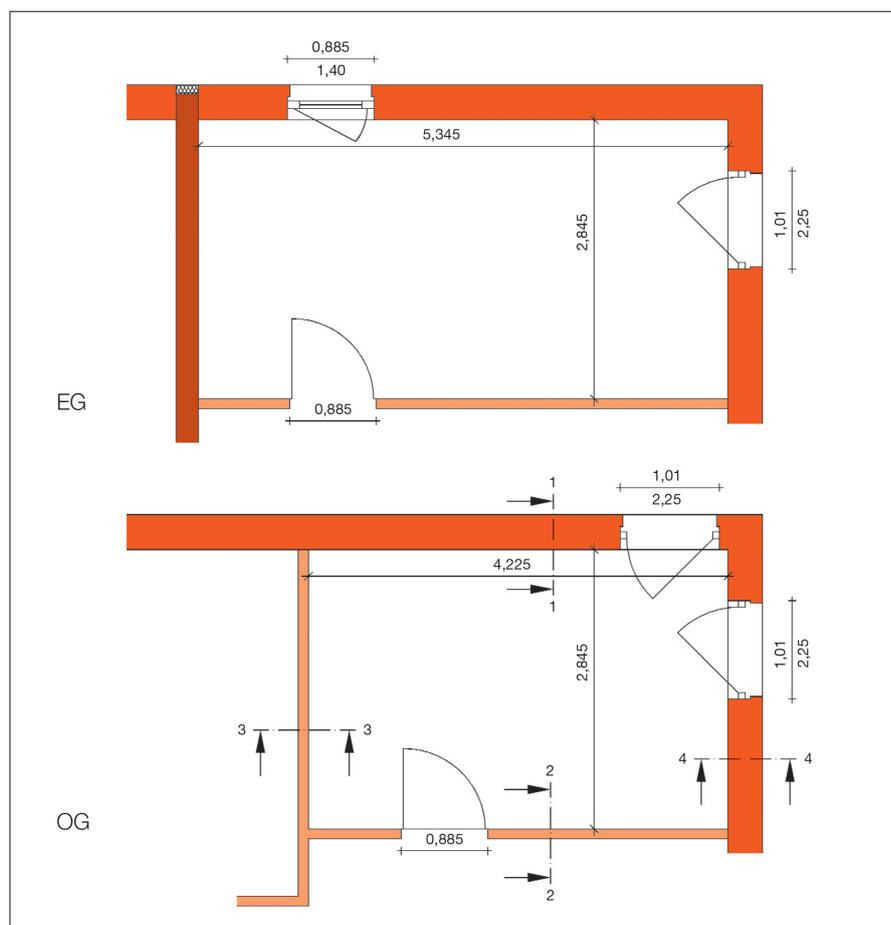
Grundrisse zweier übereinander liegender Eckräume.
